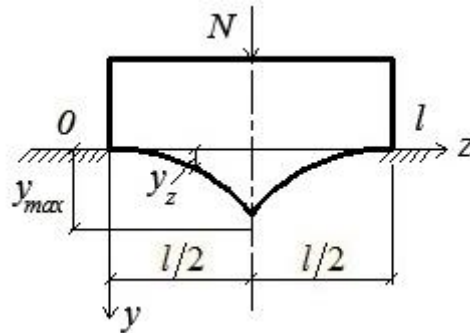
Фундамент с очертанием подошвы в форме косинусоидального клина
